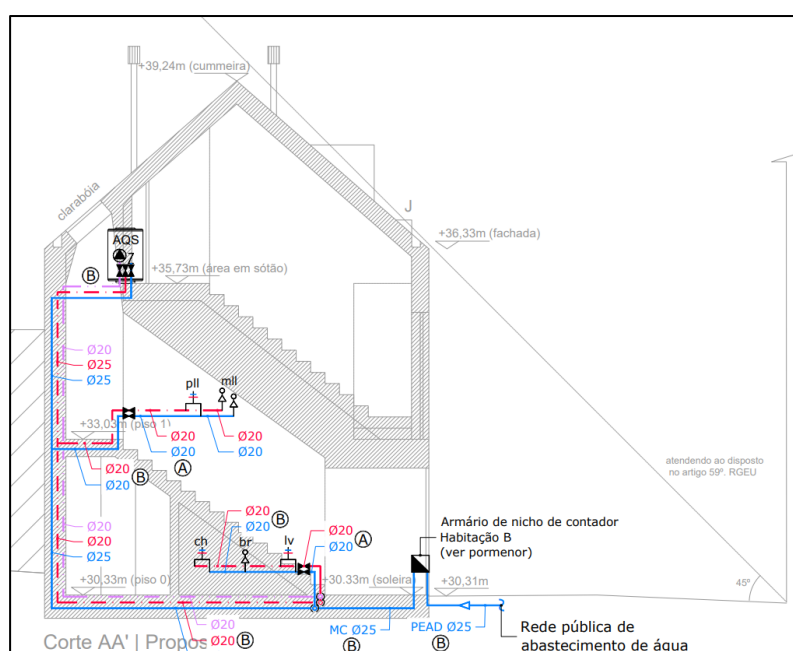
Corte transversal com o traçado da rede da habitação B (a habitação A tem traçado semelhante)
